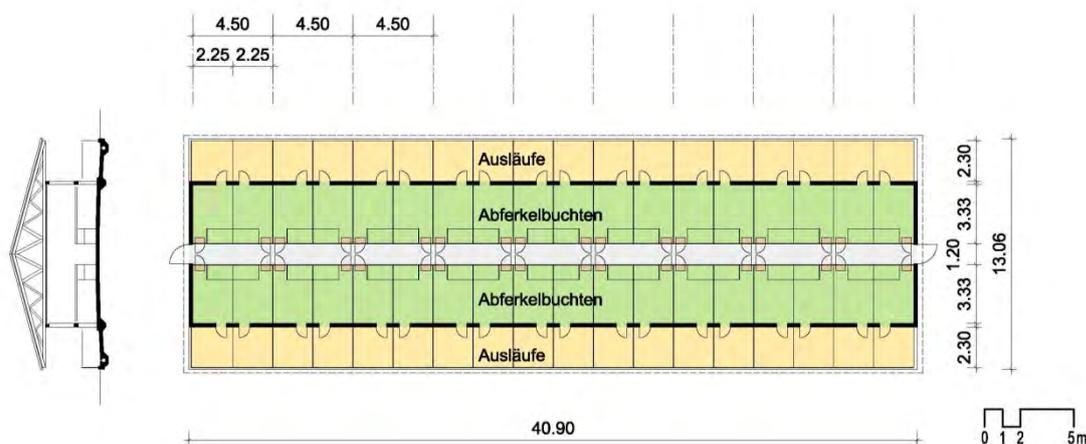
Grundriss und Schnitt des Abferkelstallabteils MODELL I mit innenliegender Fütterung
